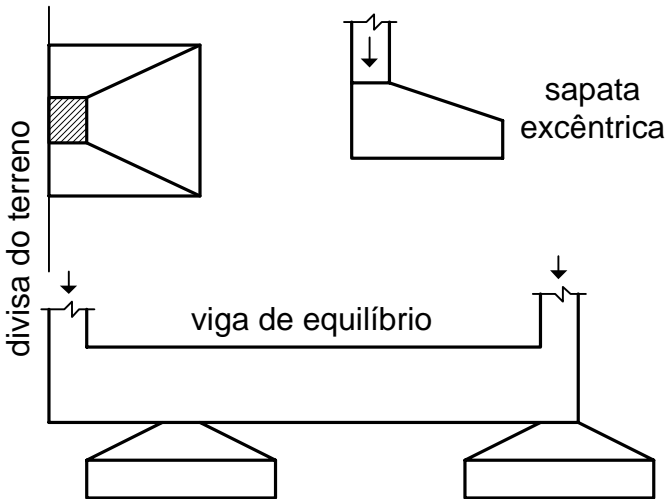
Sapata excêntrica e viga de equilíbrio
